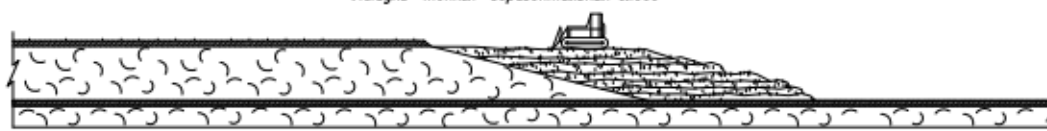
Схема укладки отходов и промежуточная пересыпка изолирующим слоем
